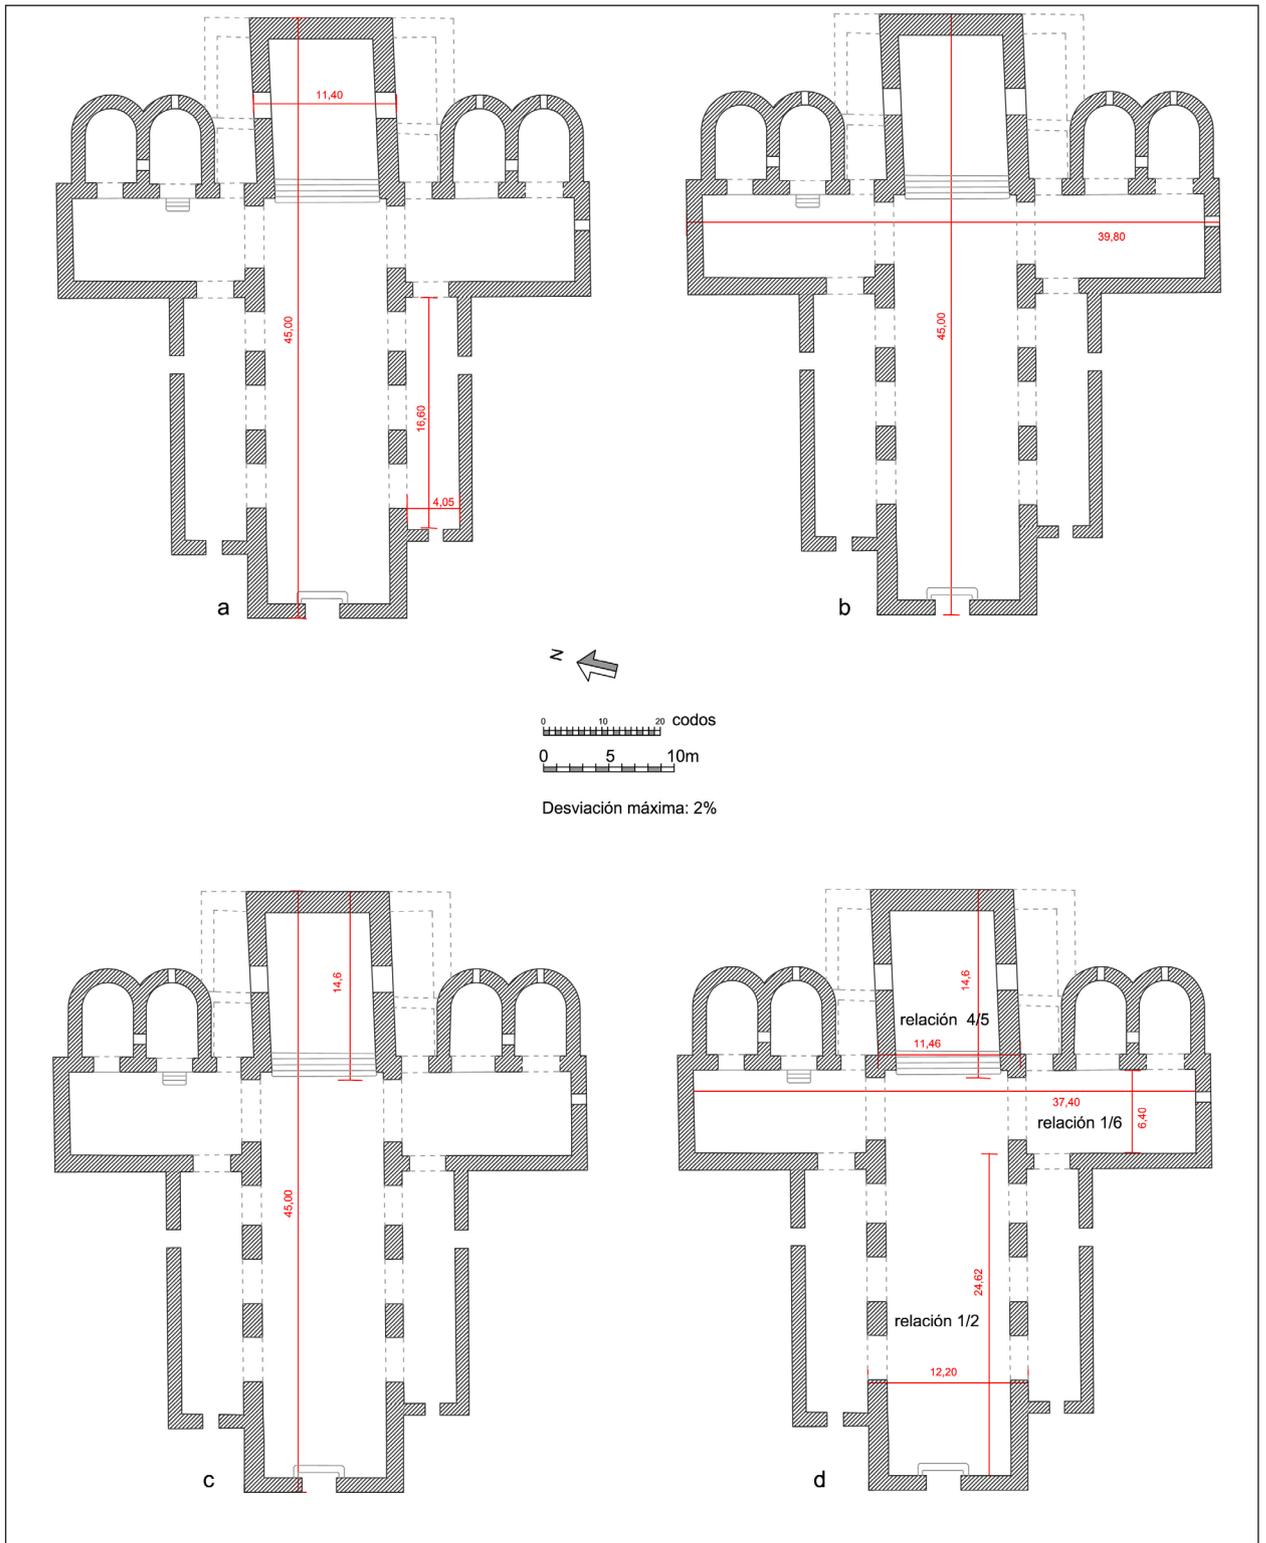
Planta de la fase del siglo X. Relaciones proporcionales. 13a: 1/4; 13b: 7/8; 13c: 1/3; 13d: 4/5, 1/6 y 1/2 (planimetría de la autora).
